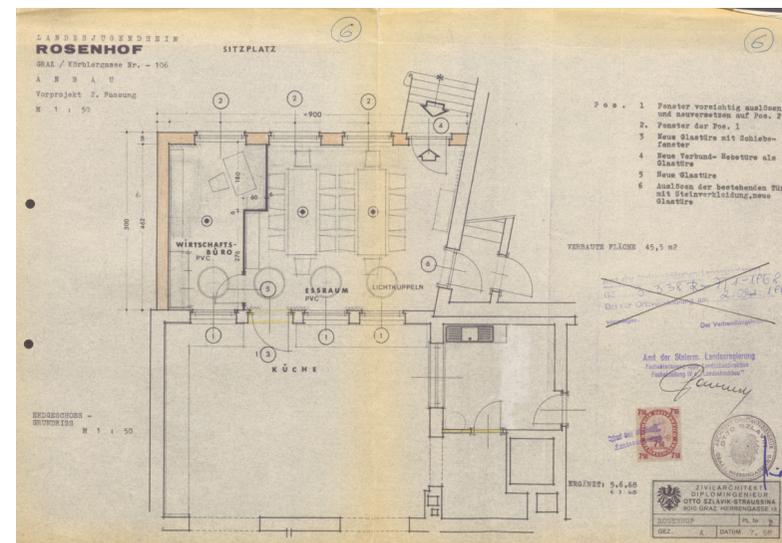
Ausbau/Zubau (Szlavik-Straussina, Essraum 1968)
